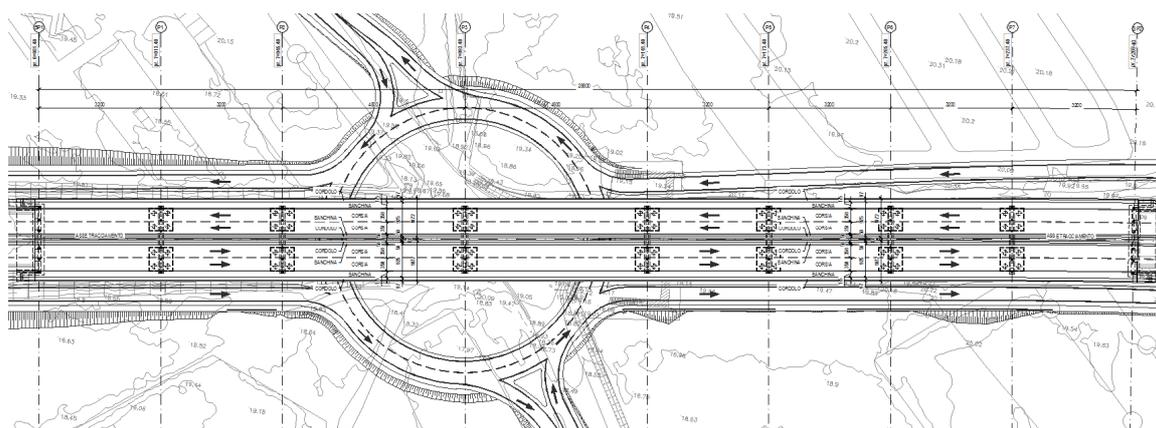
Planimetria di progetto - Viadotto Selargius Ovest
